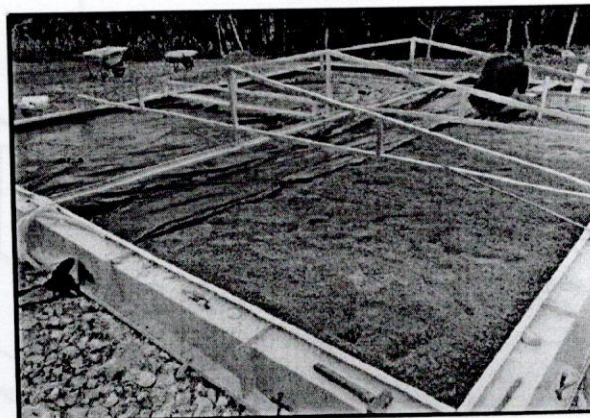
Aterro no interior da forma e colocação da lona plástica.
